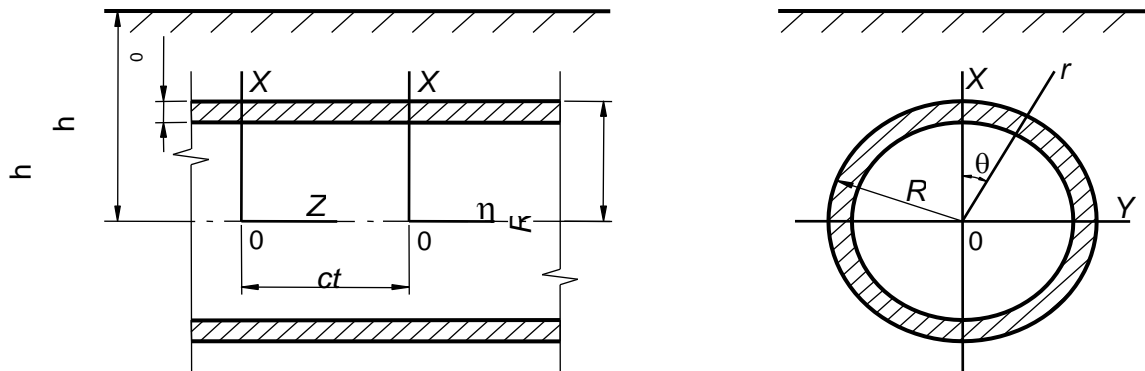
Расчётная схема подкреплённого тоннеля и подземного трубопровода
